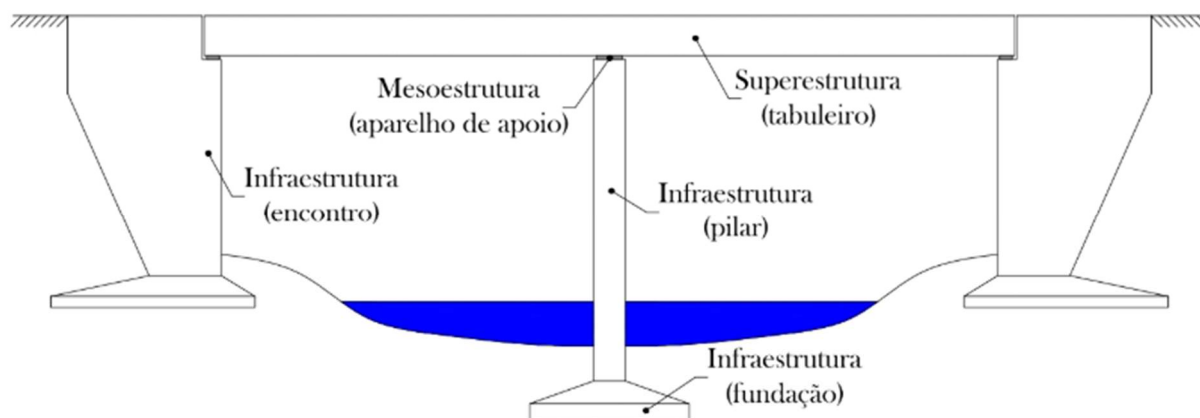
Separação das estruturas de pontes conforme Marchetti
